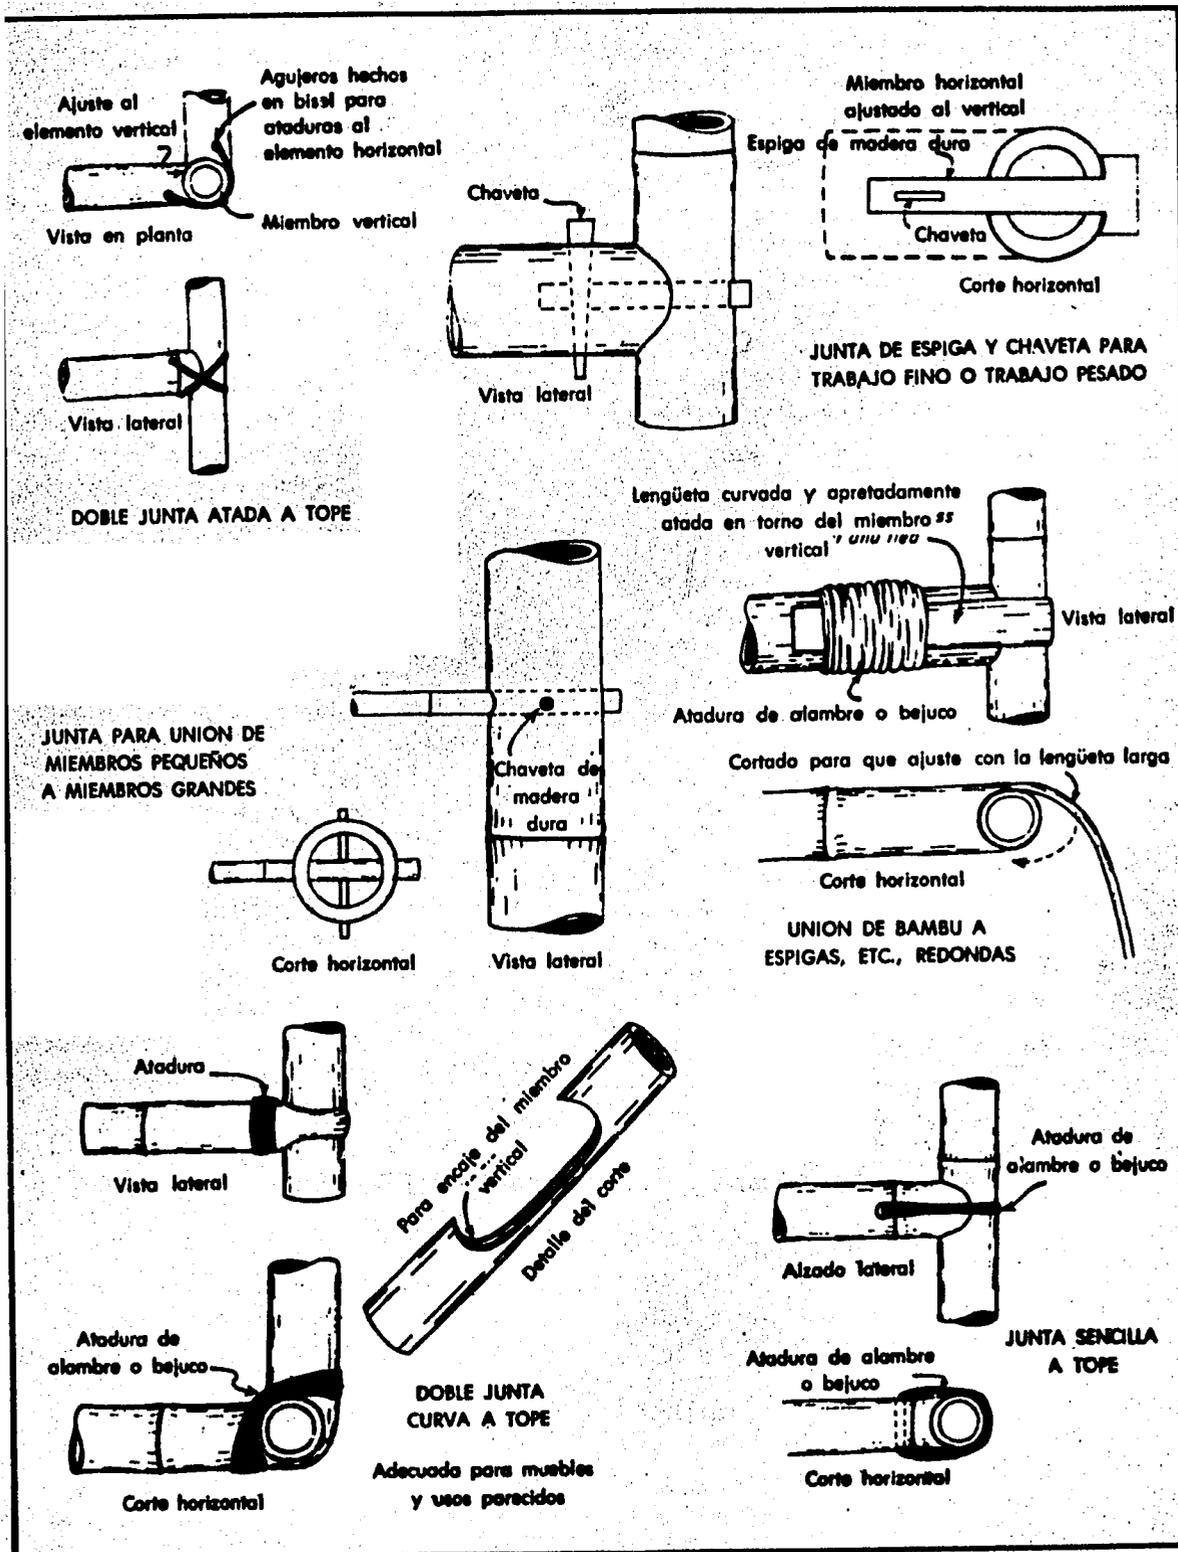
JUNTAS EMPLEADAS EN CONSTRUCCIONES CON BAMBU
